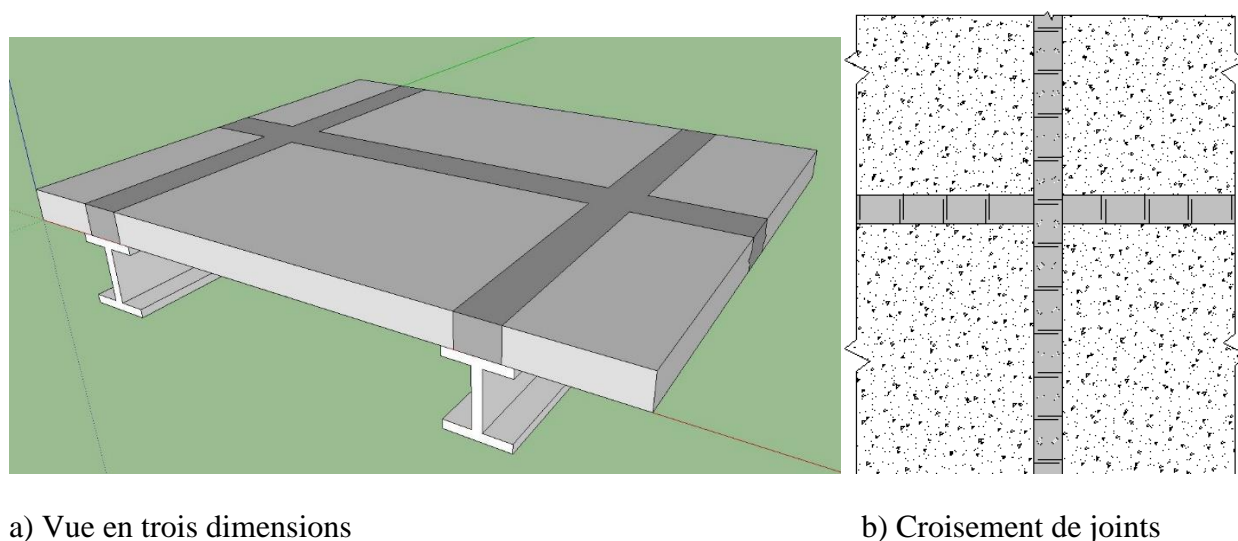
Configurations des joints longitudinaux et transversaux entre dalles préfabriquées
